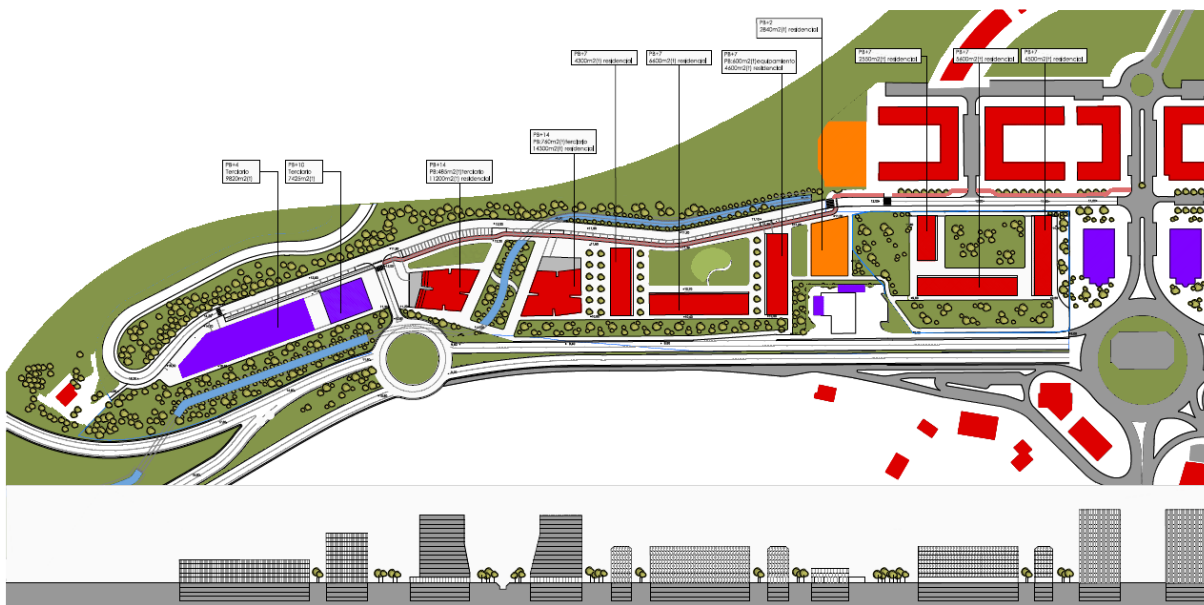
Planta y alzado general de la alternativa 2. Fuente: Modificación del PGOU.
